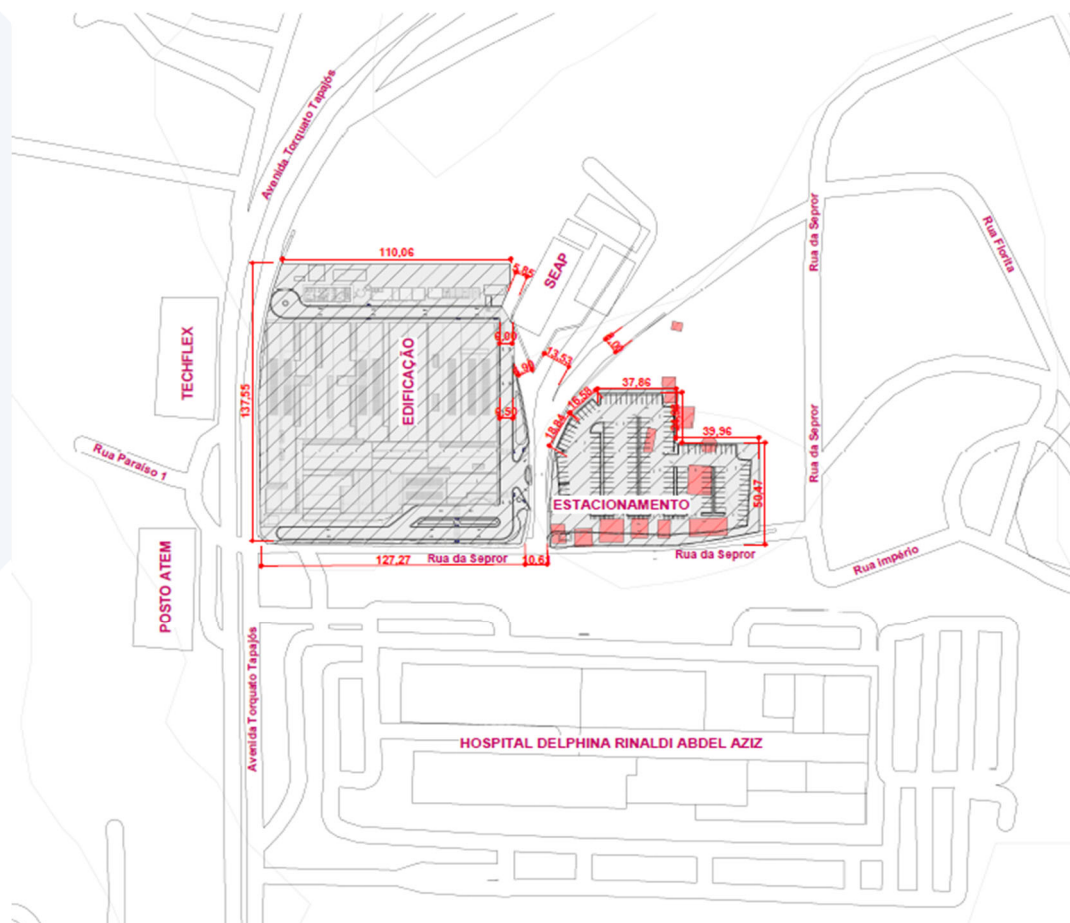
Planta de localização do empreendimento. Fonte: Projeto de localização, 2025.
